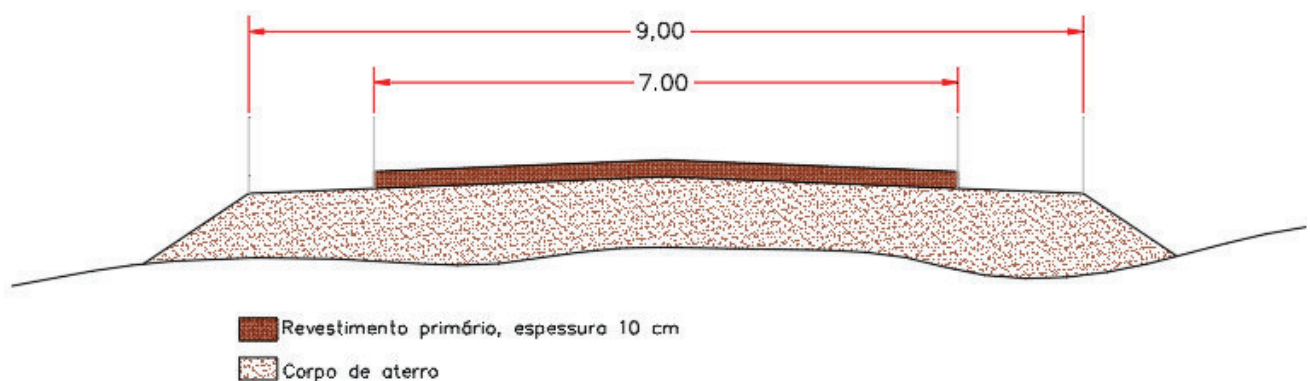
SEÇÃO TRANSVERSAL PISTA ABAULADA (RETAS)
